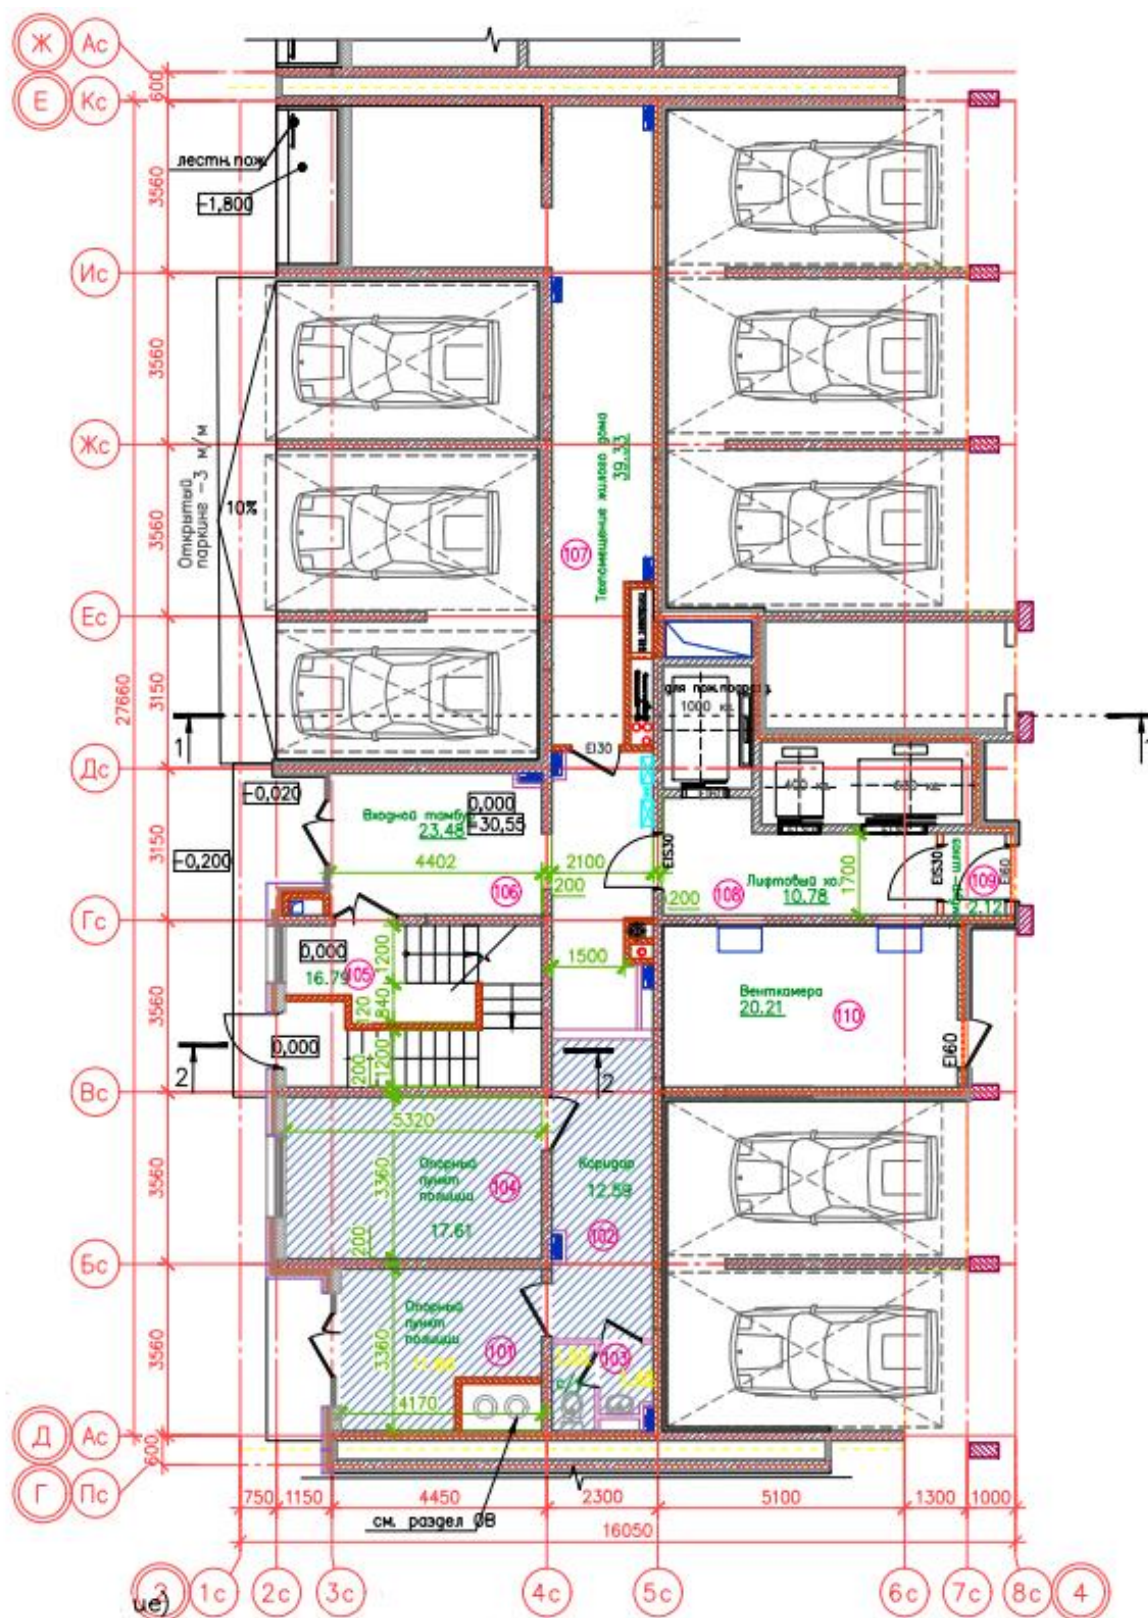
План 1 этажа БС-2 ЖК URAL
